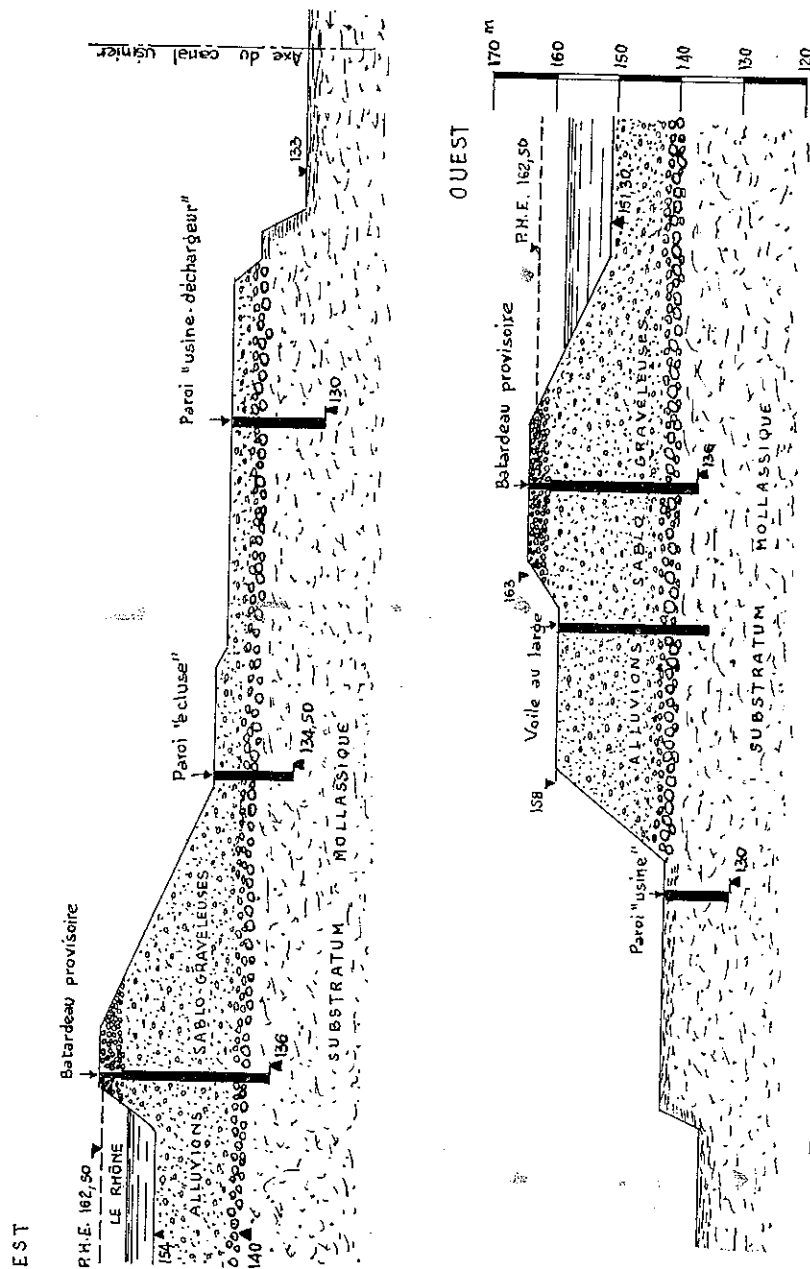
b. — Coupe suivant l'axe longitudinal de l'usine du barrage de Pierre Bénite (Rhône).
